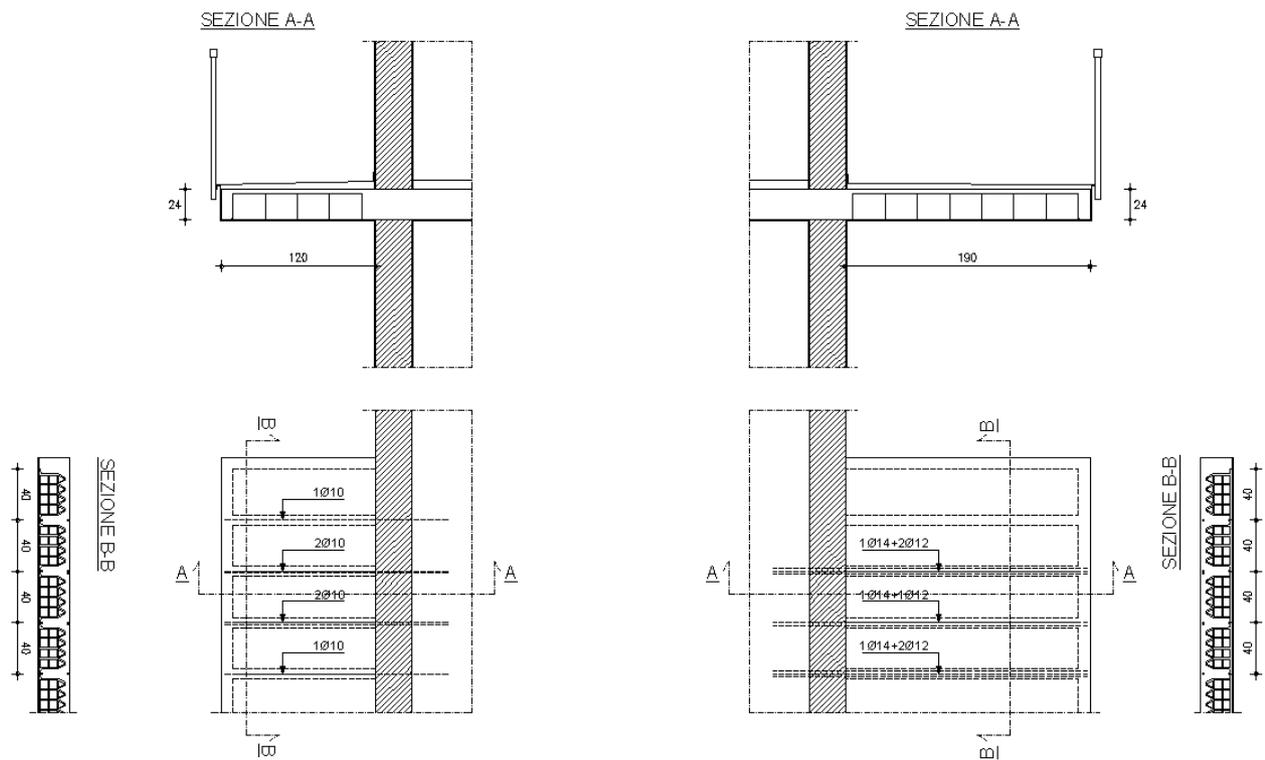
Balcone est – estradosso: rilievo delle armature (1d14 + 2d12 alternati a 1d14 + 1d12)
